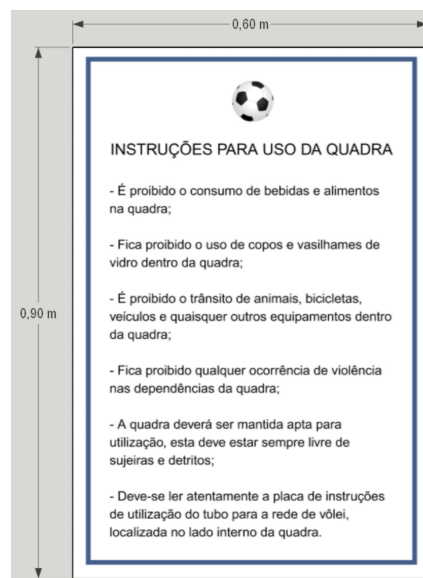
Detalhe Ilustrativo de placa de instruções (Fonte: Autor/2025)
